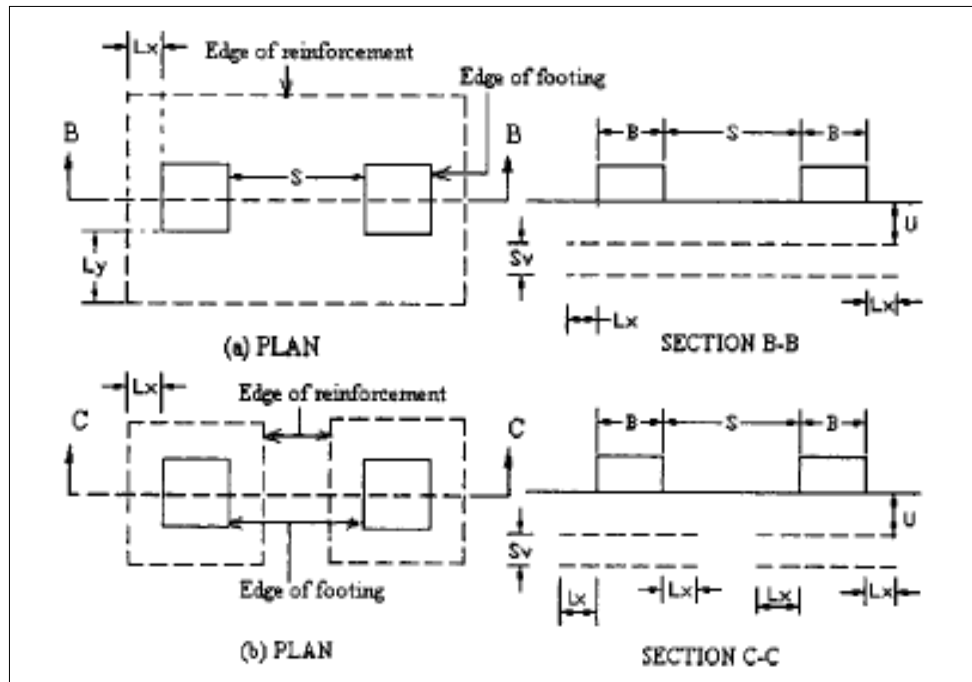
Les types de renforcement des fondations:(a) renforcement continu; et (b) renforcement discontinu
